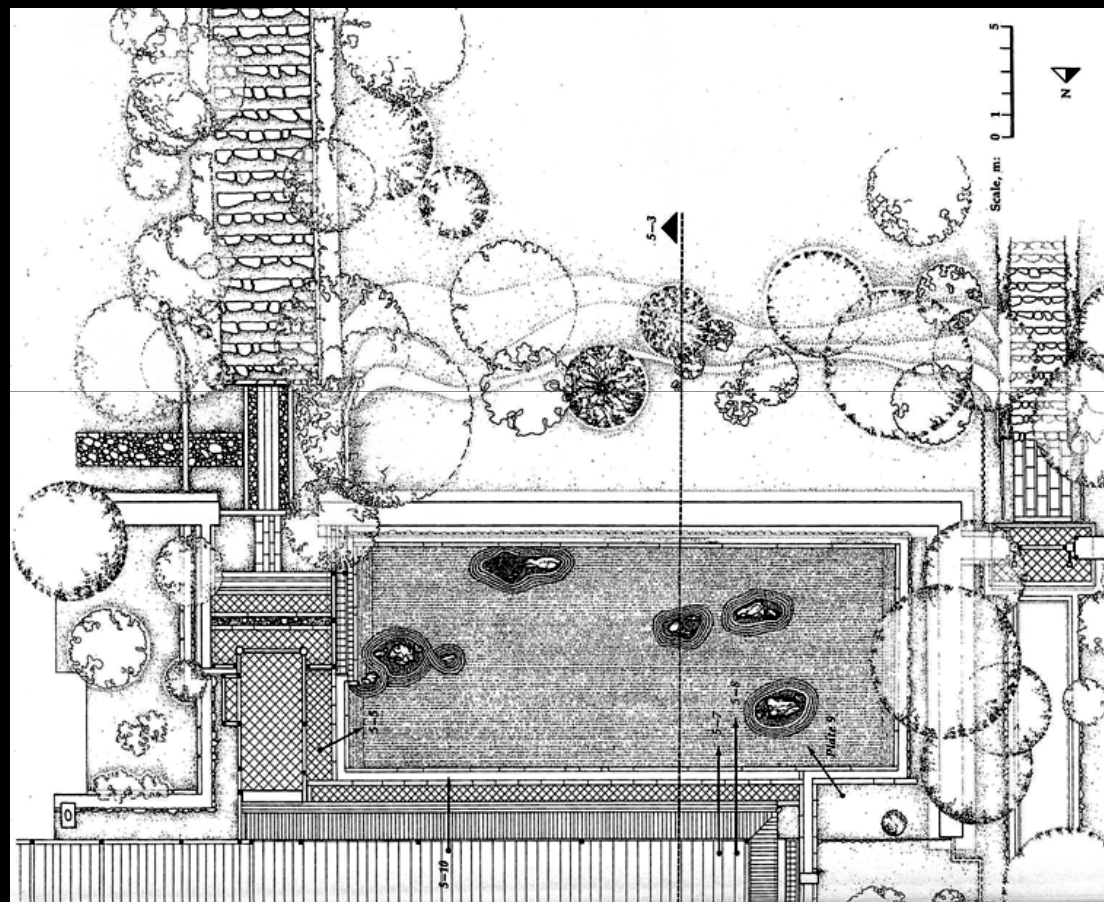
PLANTA DO JARDIM DE PEDRAS
